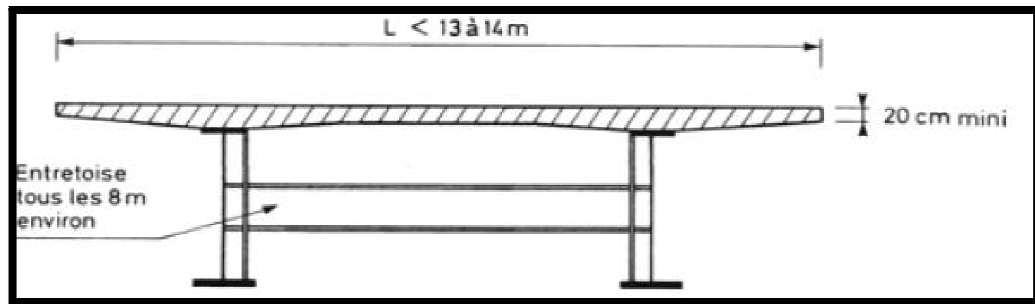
Coupe transversale d'un pont bipoutre mixte.
